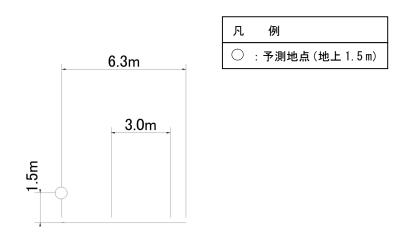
(4)予測断面図(D.一般県道車屋大久保線沿道(伊那市東春近 4838 地先))
